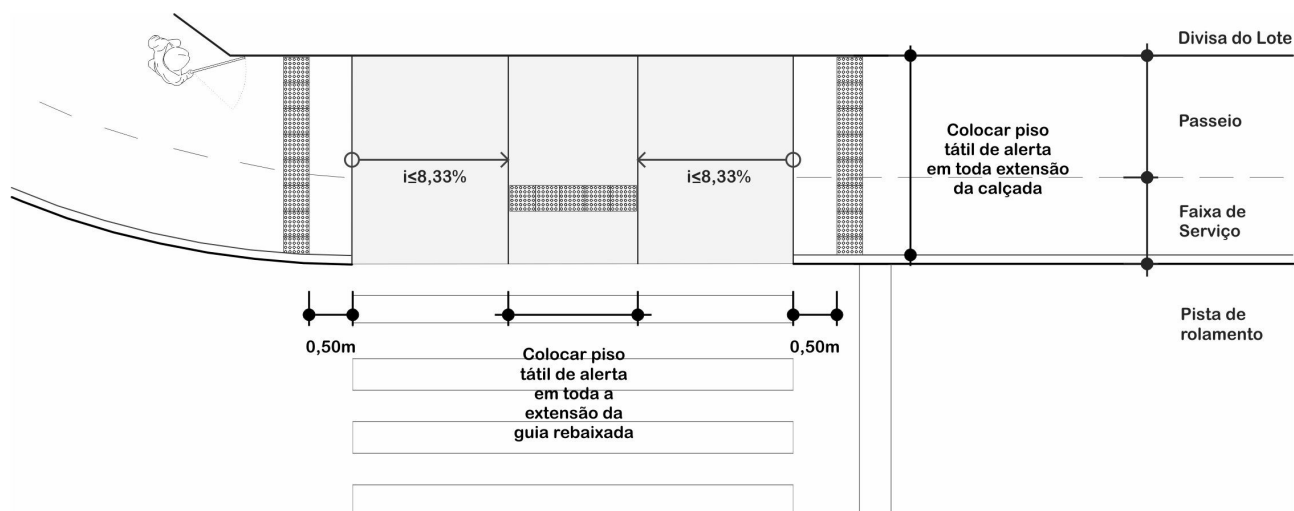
Sinalização tátil para indicação de rebaixos longitudinais para acesso de pedestres.
